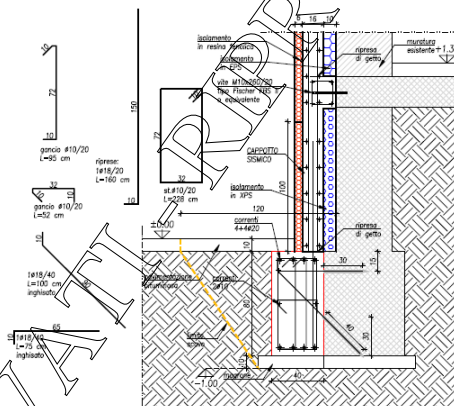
Collegamento delle nuove fondazioni del cappotto sismico alle fondazioni esistenti
